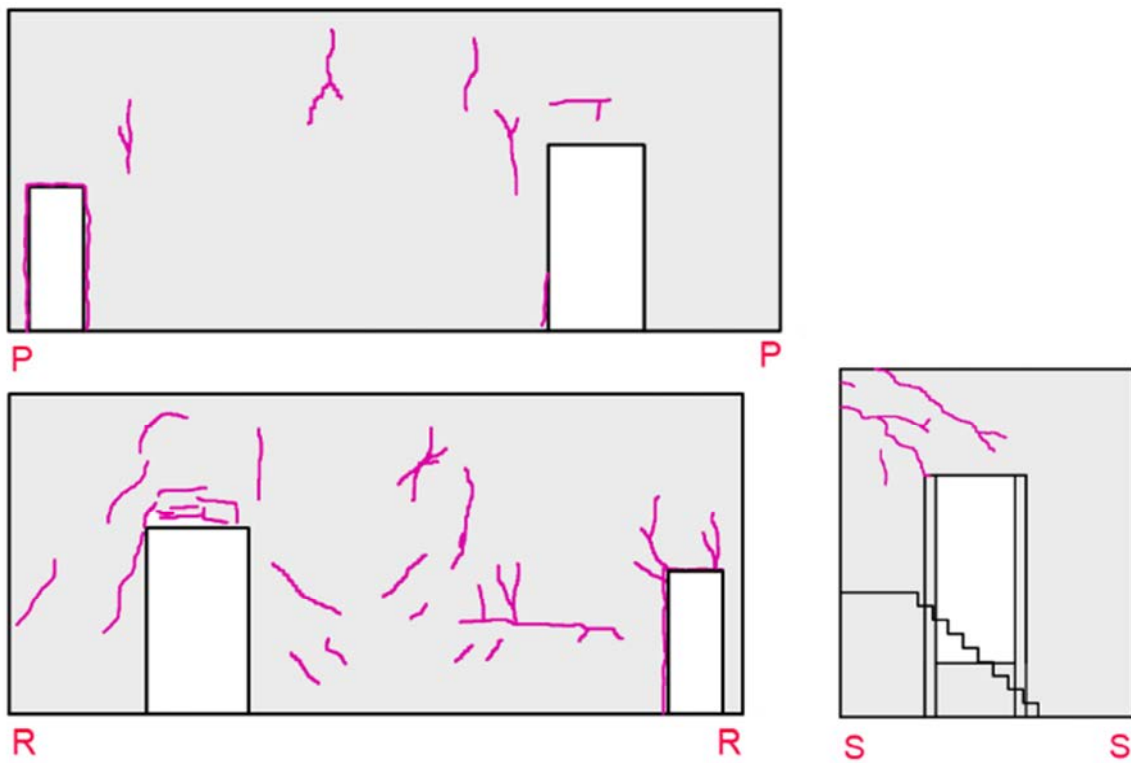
Schematizzazione di alcuni muri fessurati del piano secondo.
